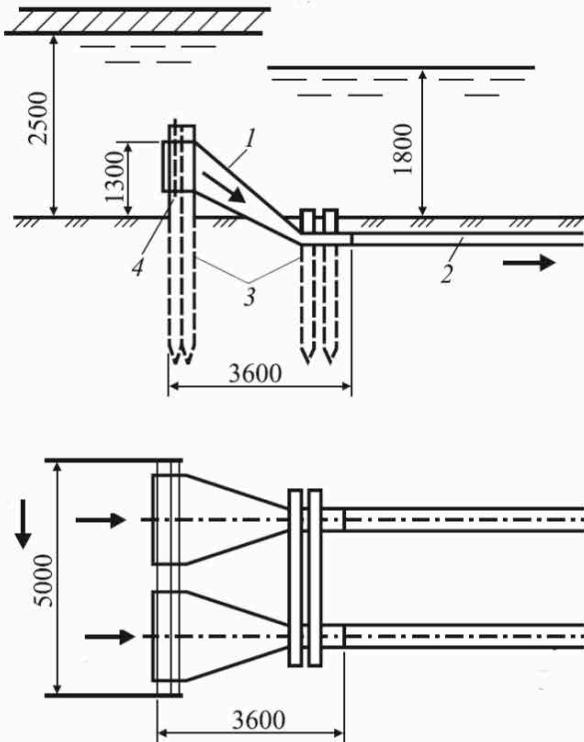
Раструбный свайный незащищенный оголовок:
